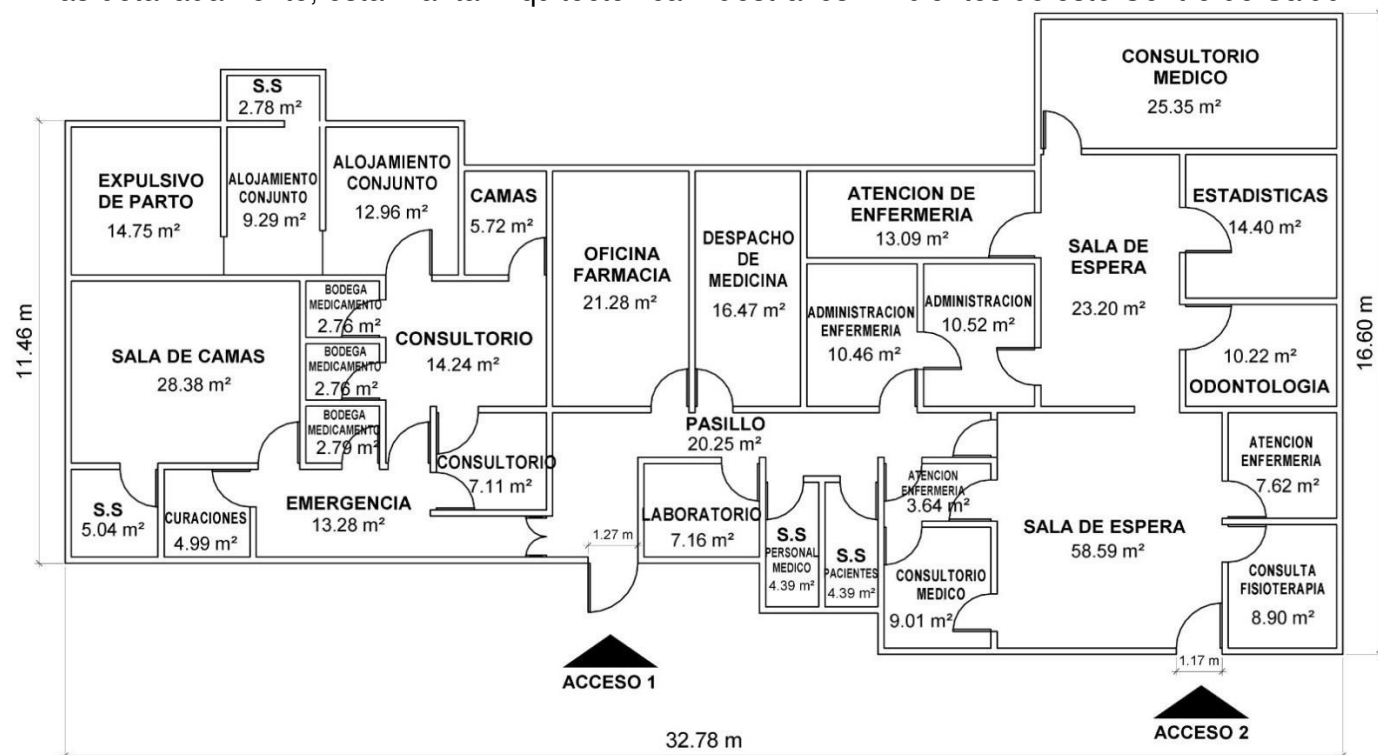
PLANTA ARQUITECTONICA CENTRO DE SALUD GASPAR GARCIA LAVIANA
